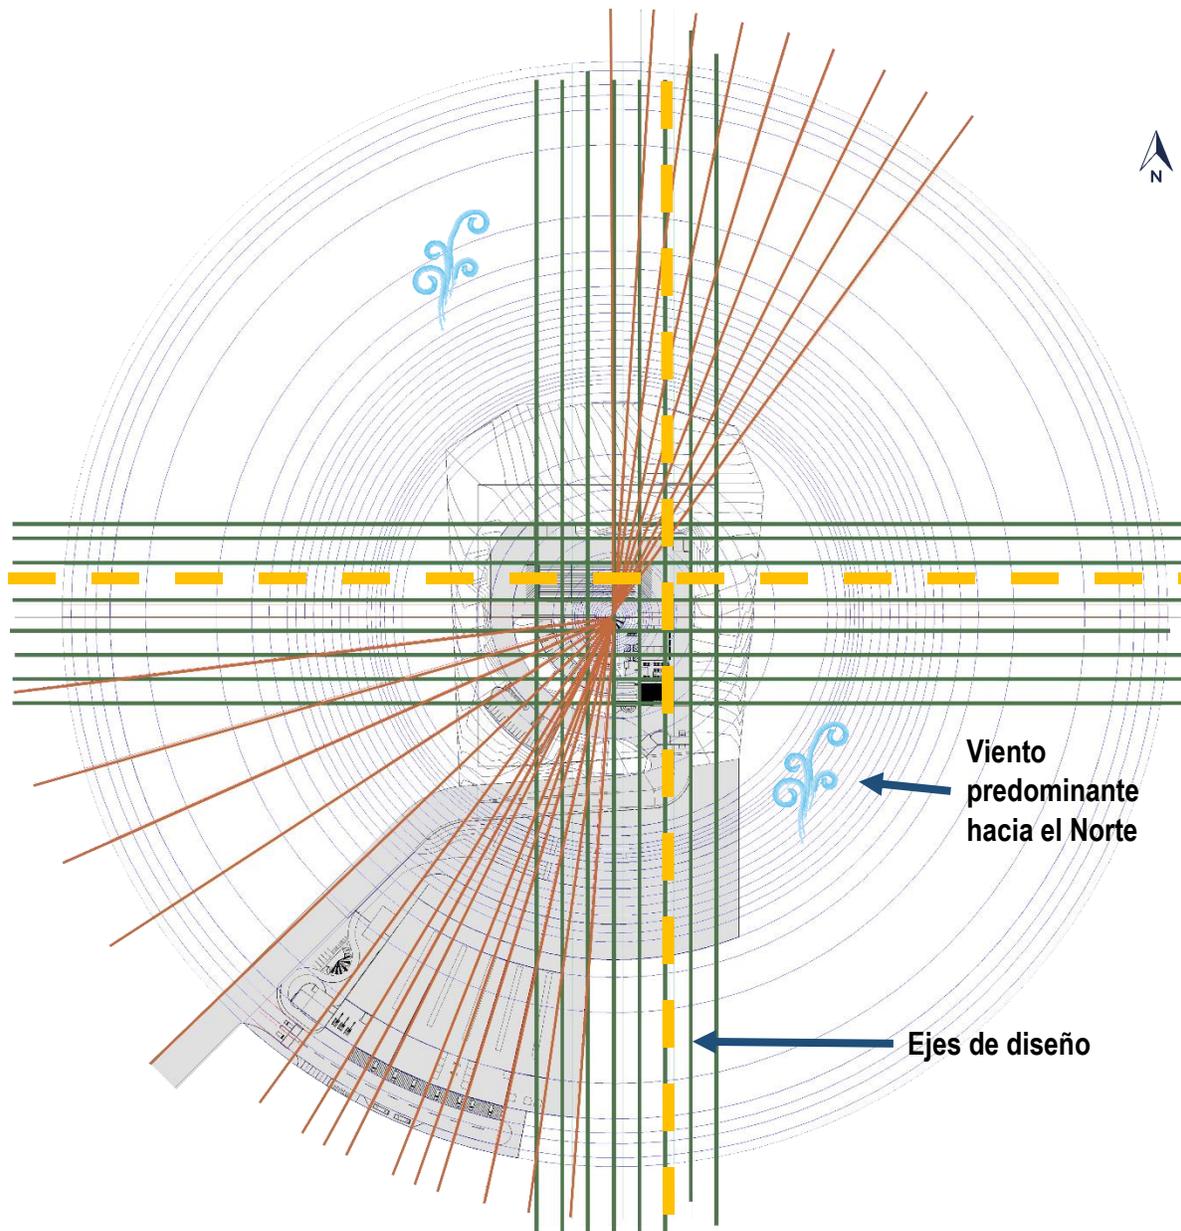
Superposición de Estructuras en la Planta Conjunto.
